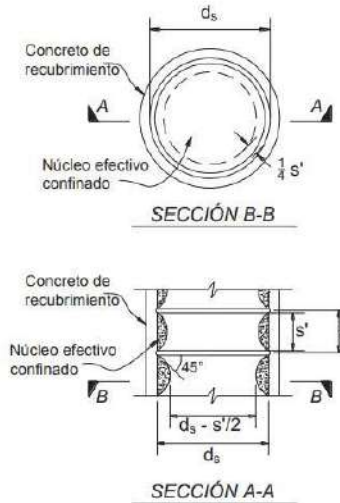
Núcleo confinado efectivo para estribos de refuerzo circulares.
